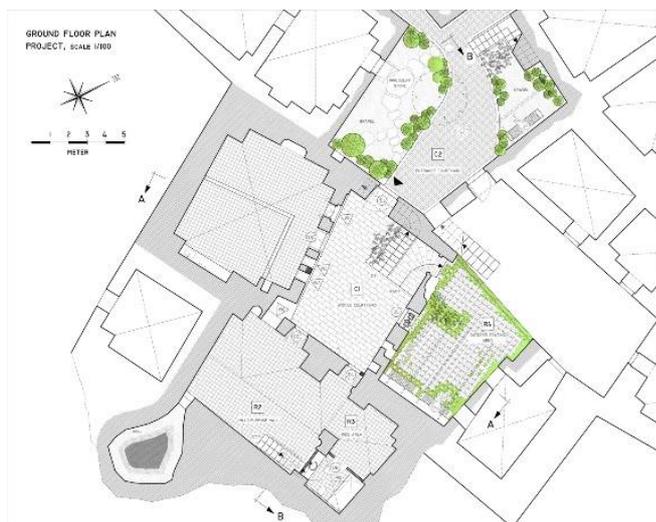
План здания Хош Нада Аль-Шуаиби. Анализ автора
